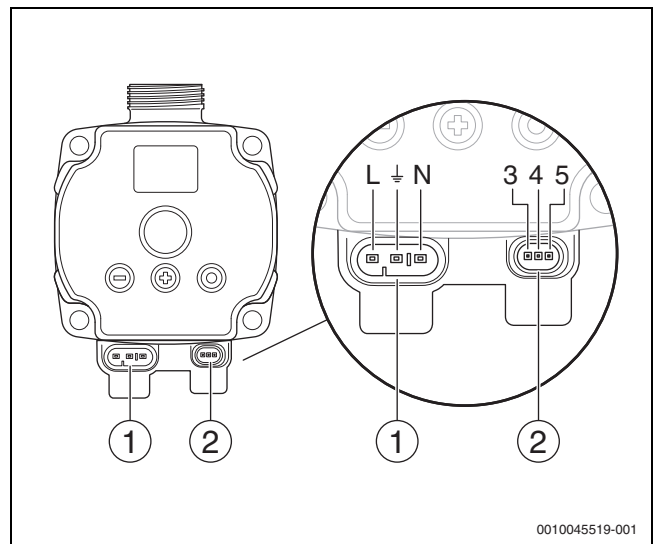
Anschlüsse Calio SI 25-80 HP PWM
